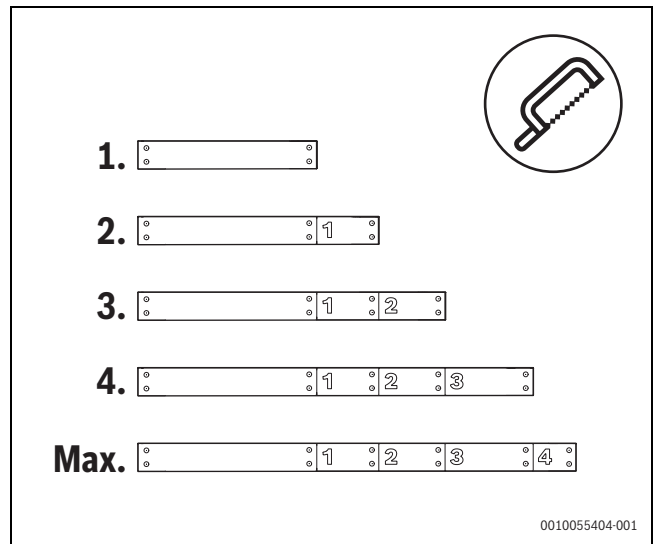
Longueurs des planches d'écartement de la fondation préfabriquée
